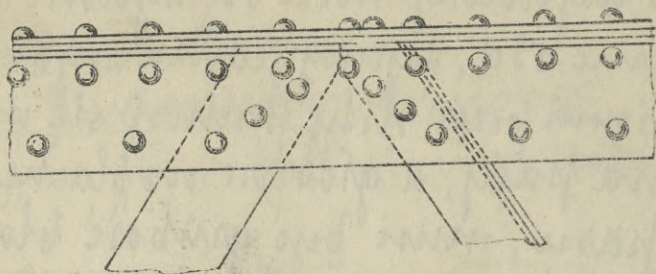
wzięta, jak wiele innych z Winklera: „Vorträge über Brückenbau“.)
